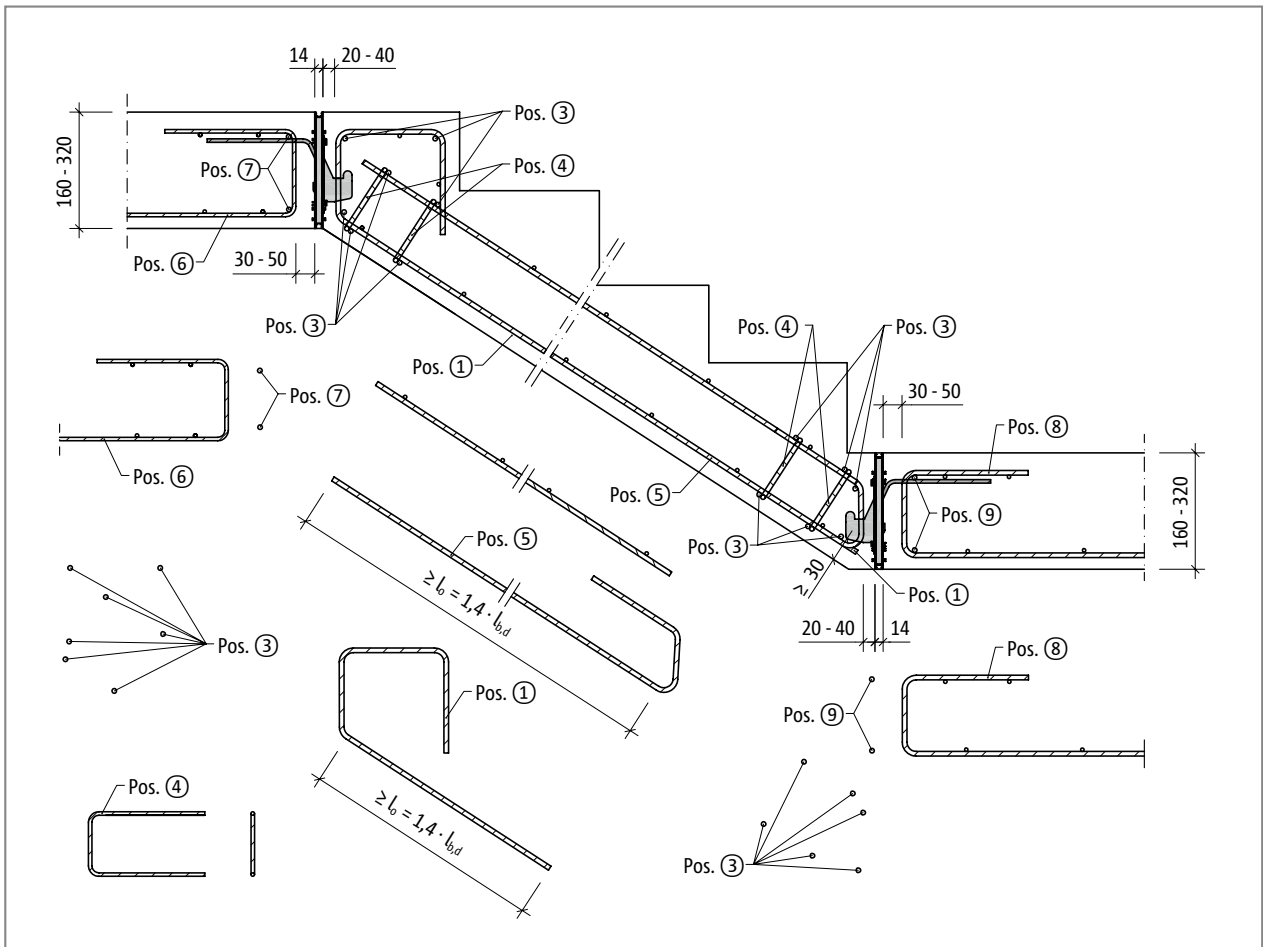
Schöck Tronsole® Typ T: Bauseitige Armierung
